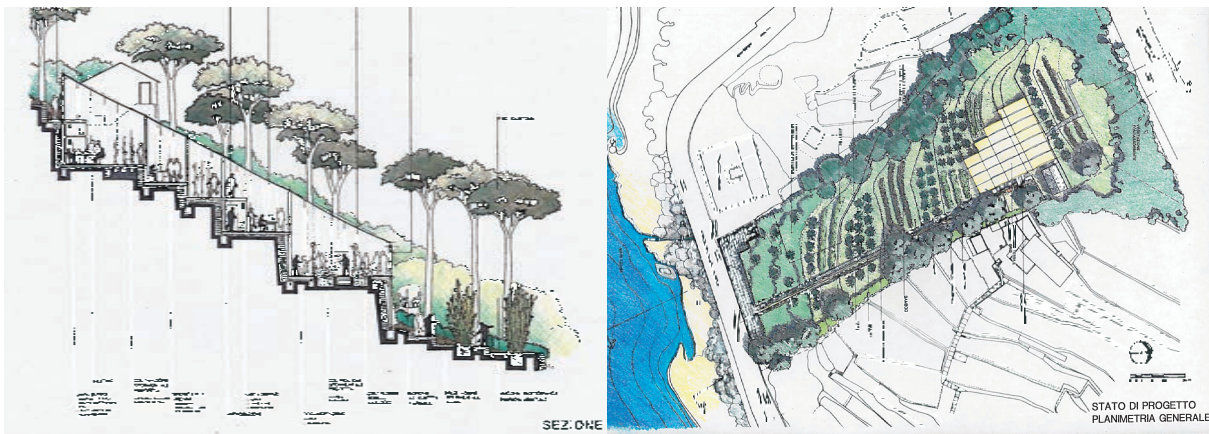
Desenho do terreno do Laboratório de Construção em Vesima. Fonte: Fondazione Renzo Piano
